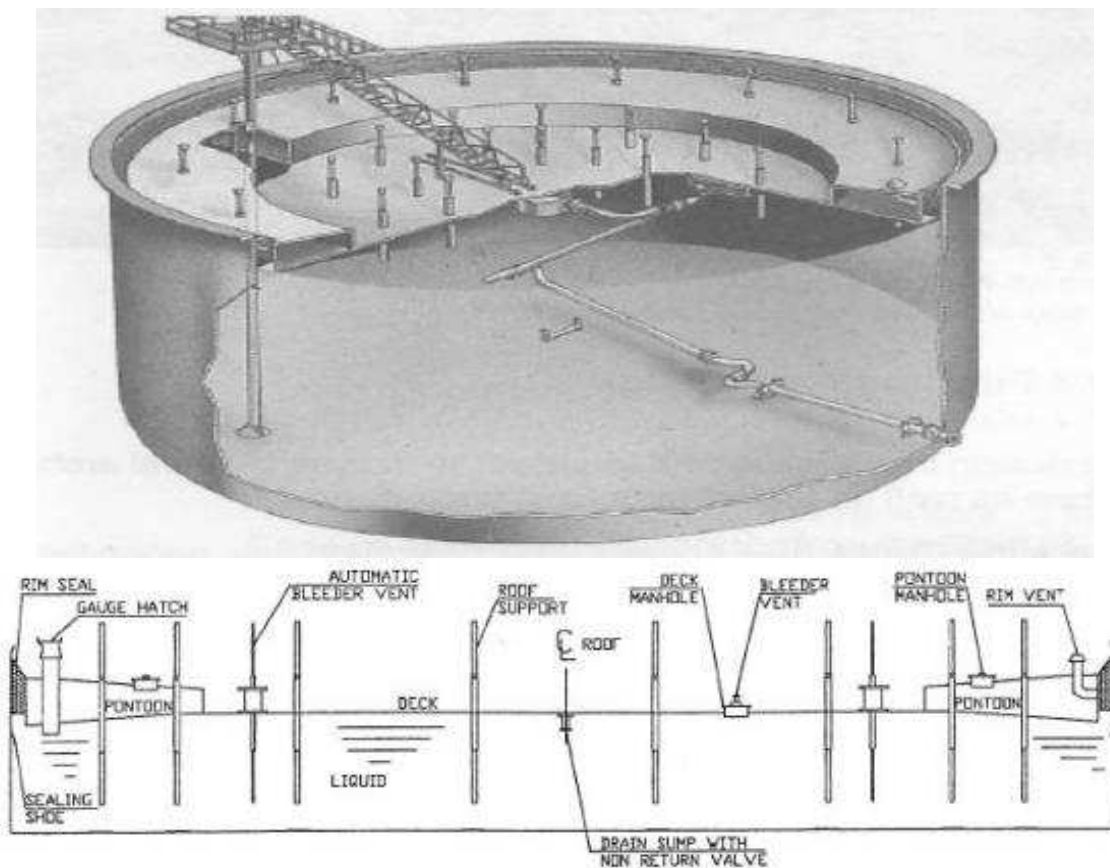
Резервуар с плавающей крышей однопалубного типа [39].
